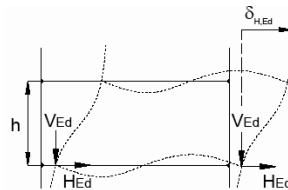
Configurazione deformata di strutture a telaio sotto azioni orizzontali e verticali
